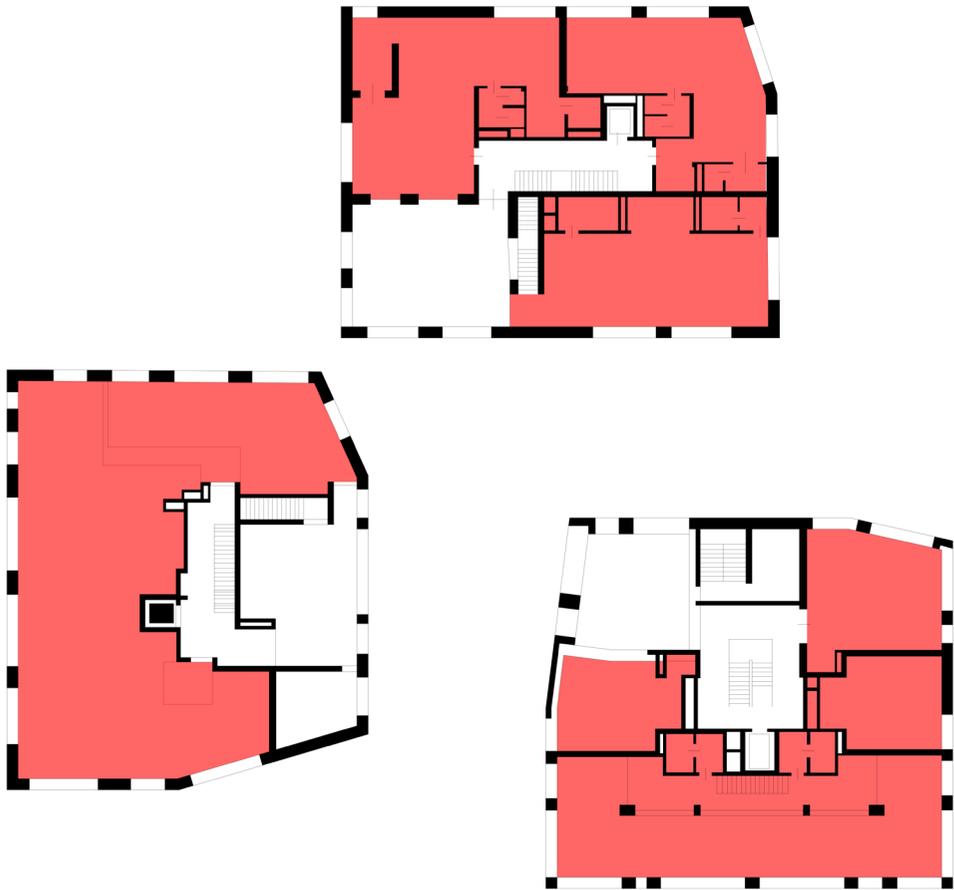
PaN-Wohnpark, Grundriss EG - Gemeinschafts- und Gewerbeeinrichtungen
